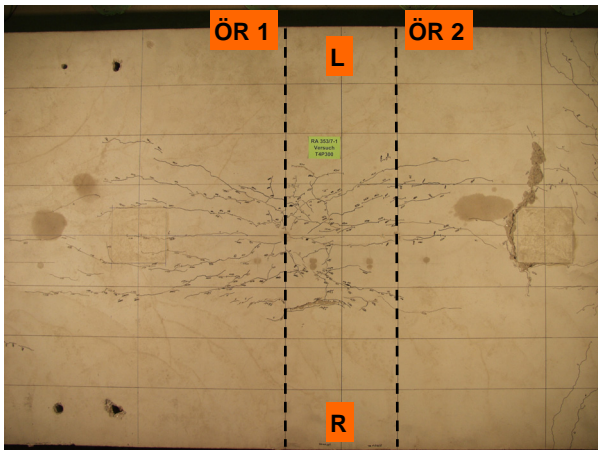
Rissbild auf der Betongurtoberseite
